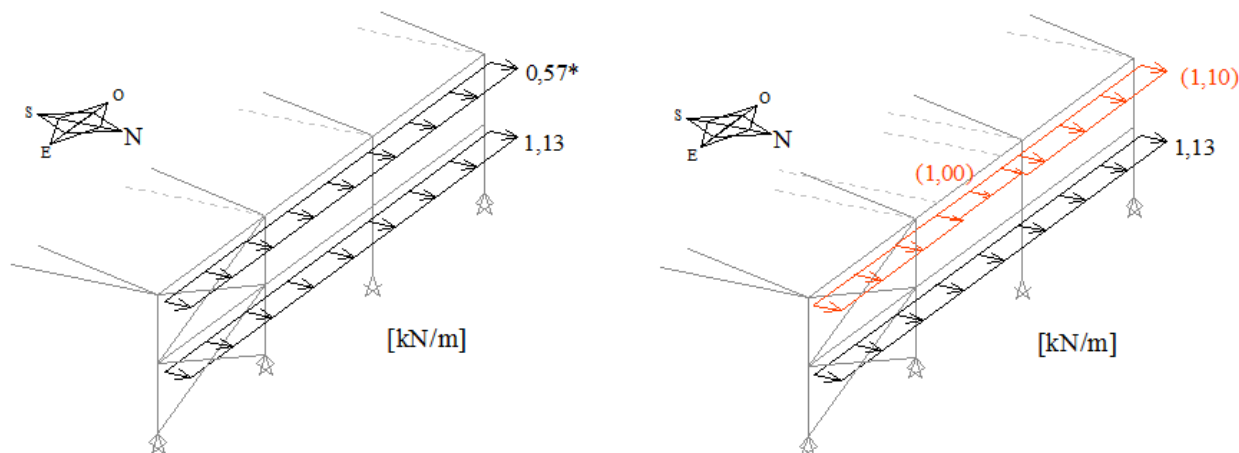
Vento W2 na fachada orientada a Norte na situação 2 (RSA)
